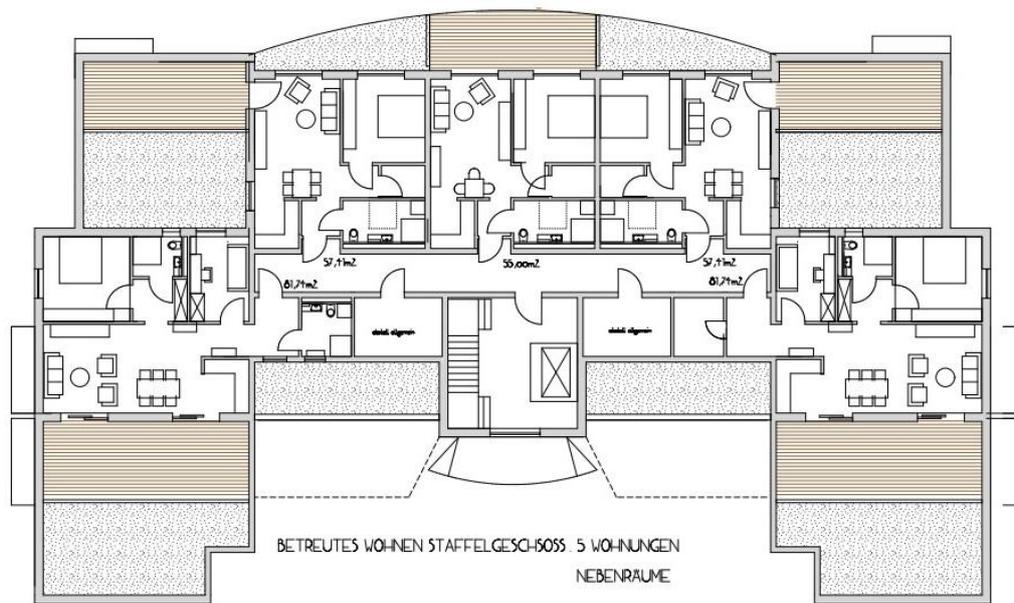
Betreutes Wohnen Grundriss Staffelgeschoss
